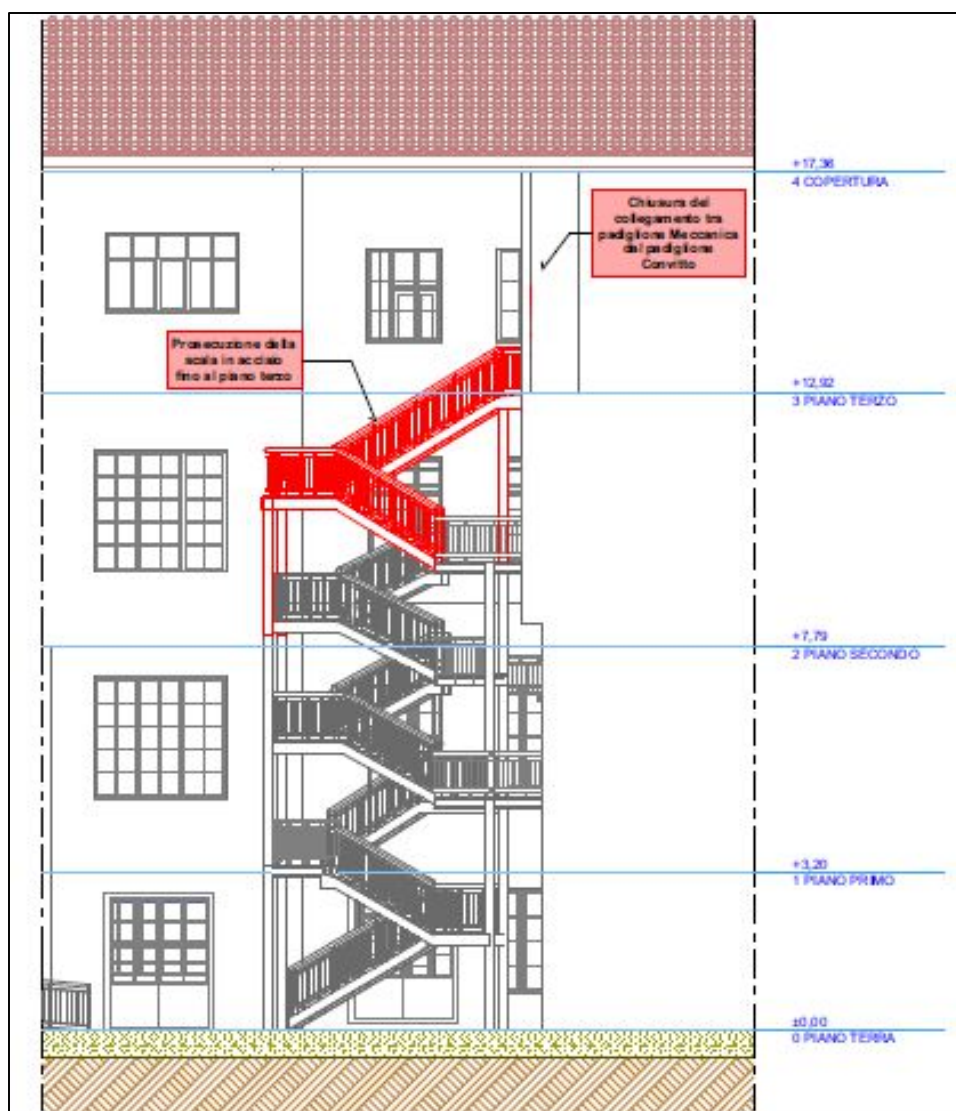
Sopraelevazione scala di emergenza esterna: prospetto sud
